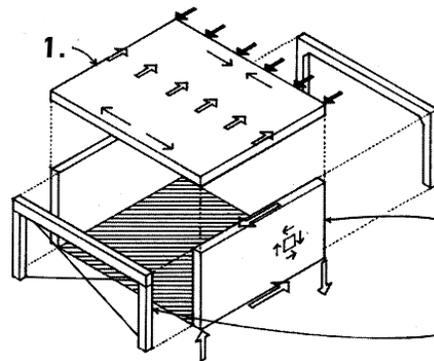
Sistema estructural Fuente: <http://www.elconstructorcivil.com/2013/09/estabilidad-lateral-elementos.html>
